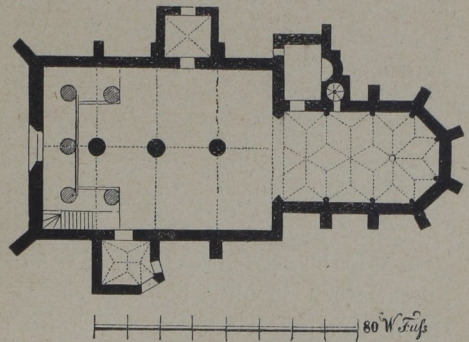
Grundriss der Stadtkirche in Blatna.
